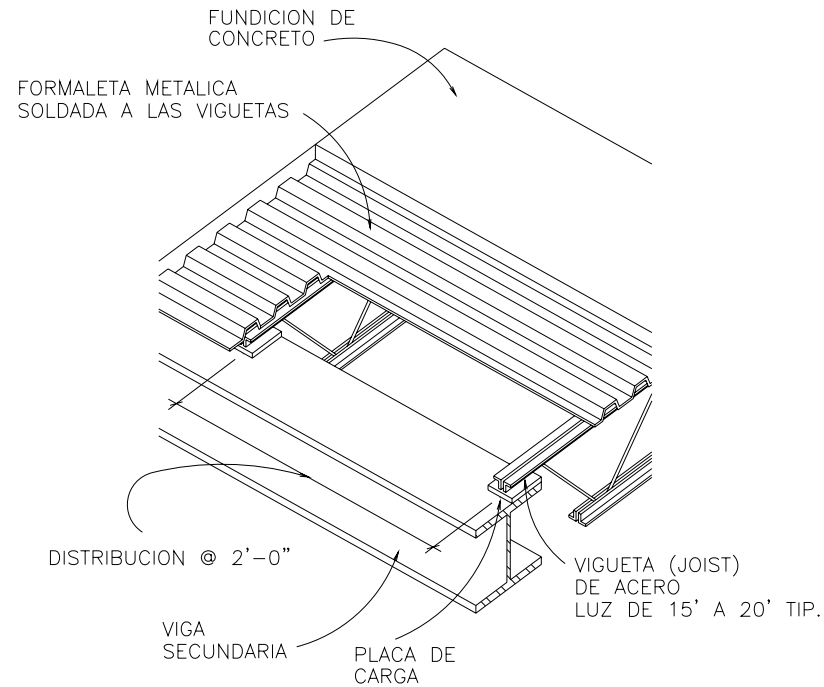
Losa fundida sobre viguetas o joist.
